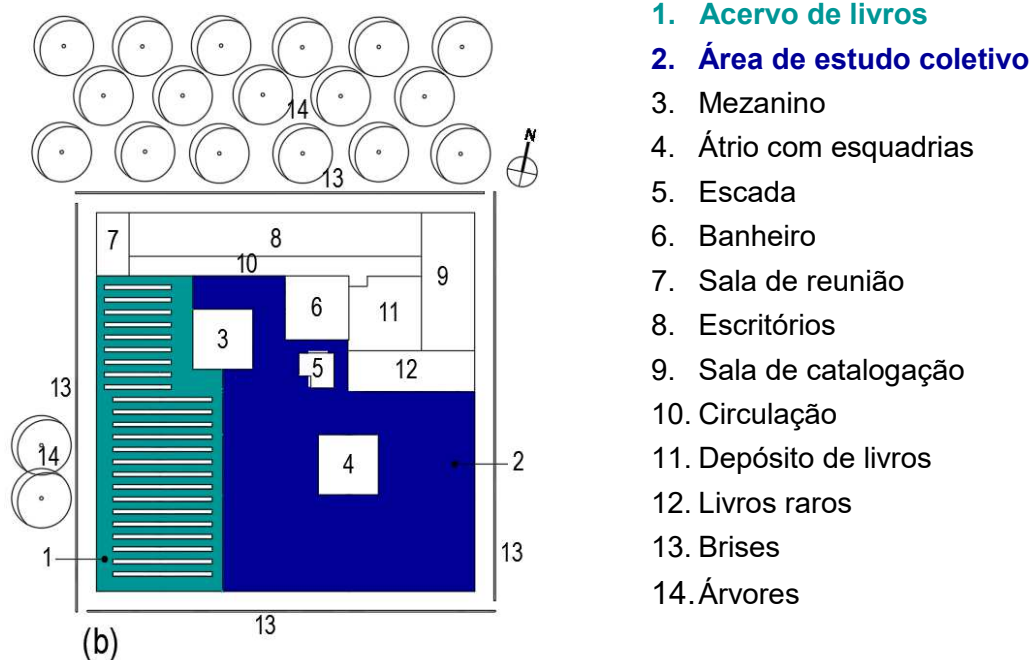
Espaços analisados hachurados no 1º pavimento.
